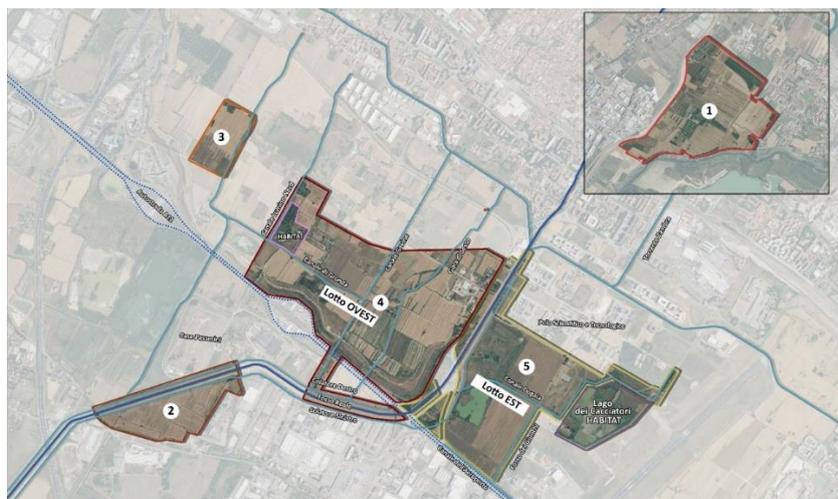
Planimetria di cantierizzazione: suddivisione in macro lotti
